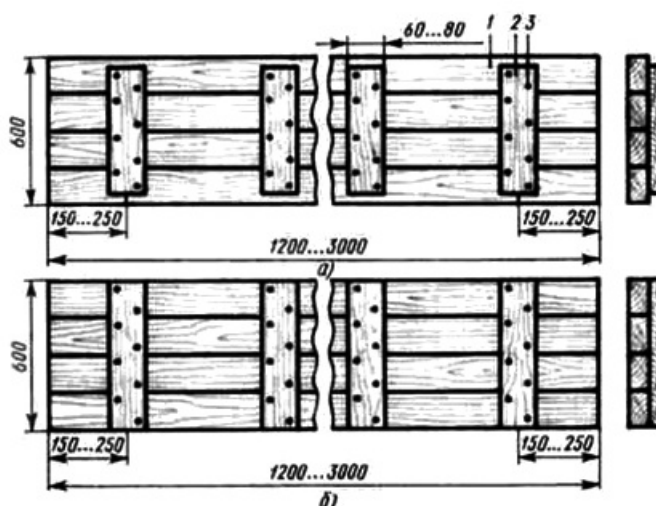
Щиты разборно-переставной опалубки для фундаментов
